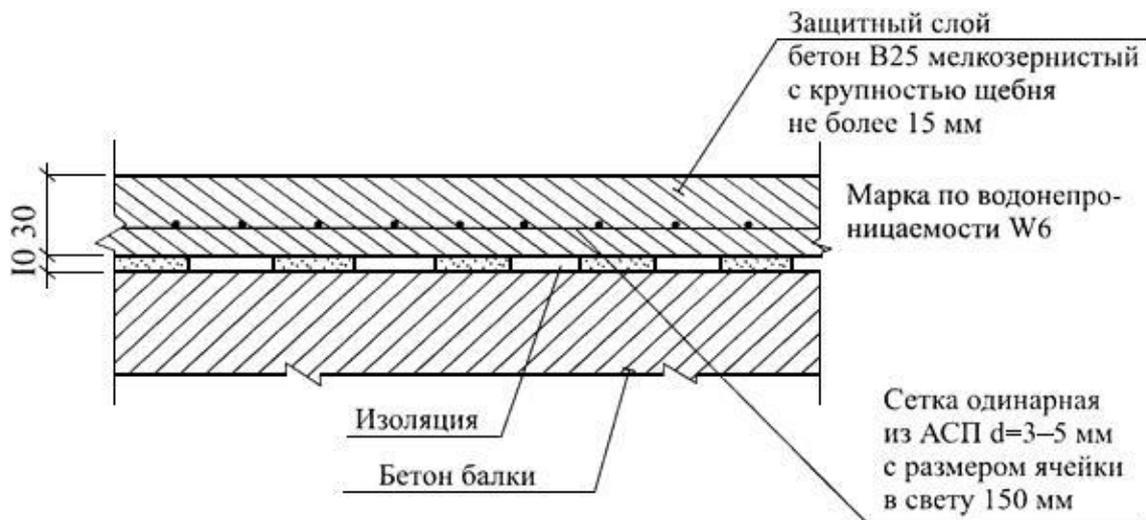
Конструкция защитного слоя бетона проезжей части с использованием композитной арматуры
